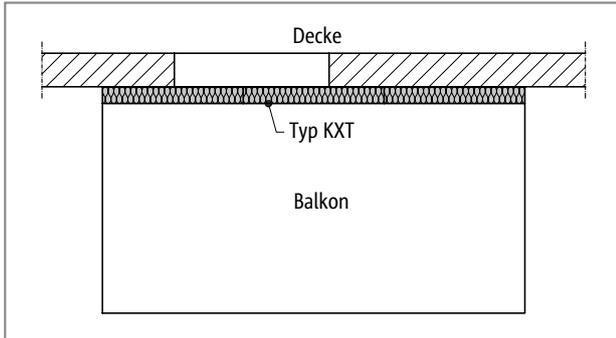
Schöck Isokorb® Typ KXT: Balkon frei auskragend
